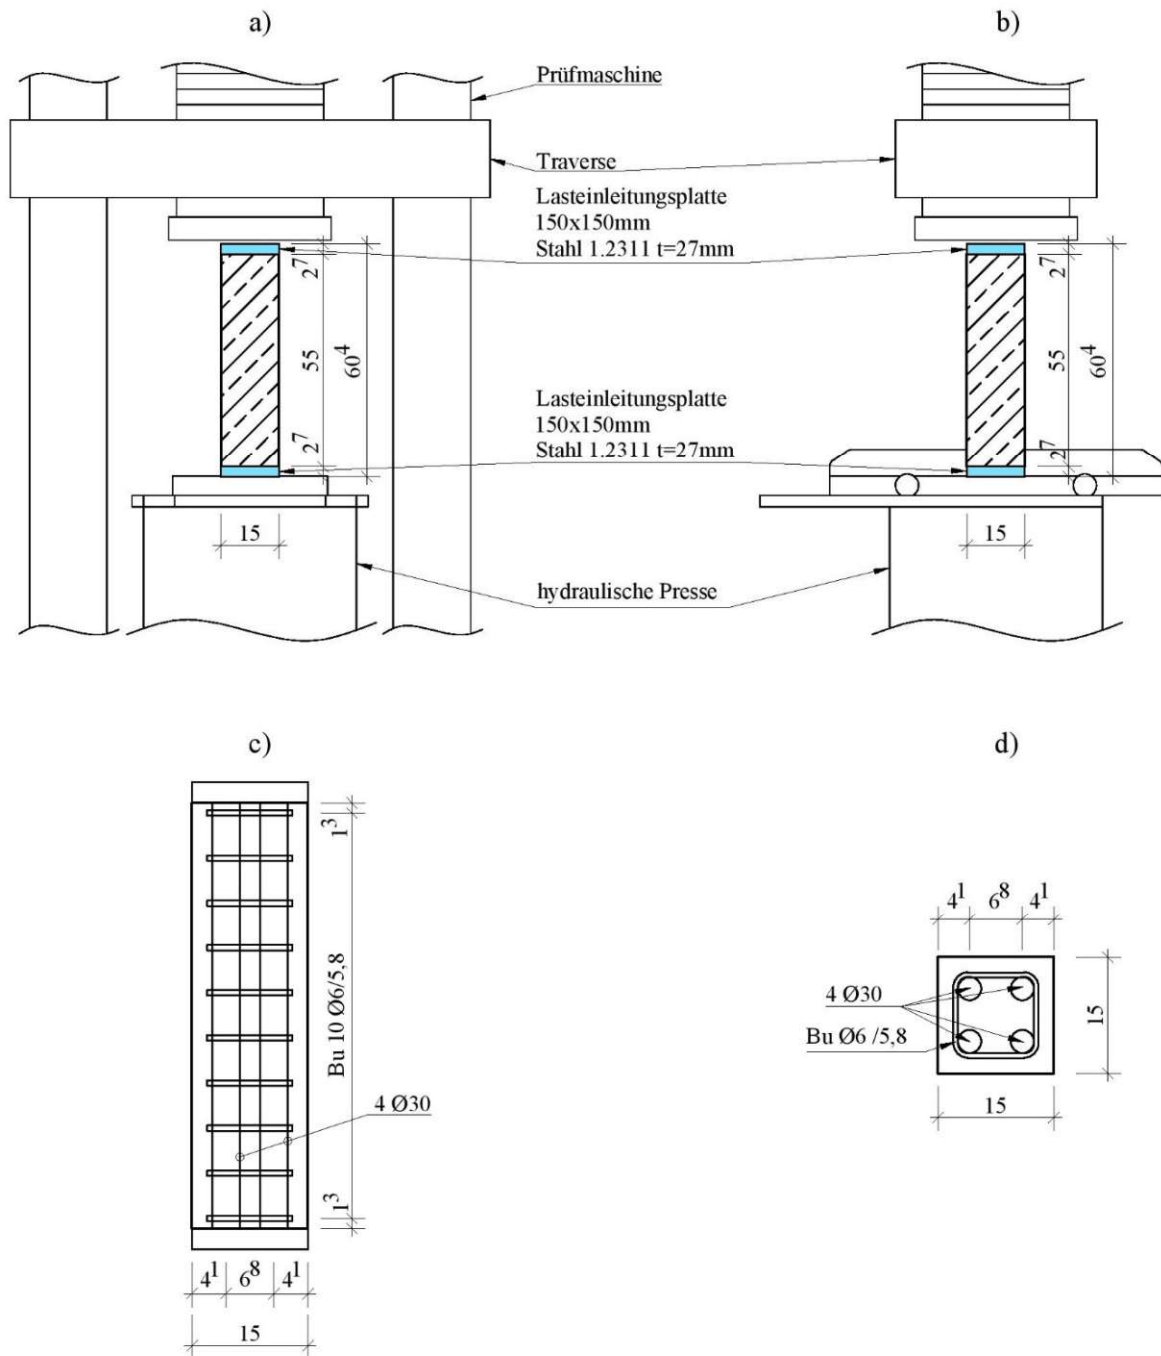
Referenzstütze a) Ansicht von vorne, b) Seitenansicht, c) Bewehrung im Aufriss, d) Bewehrung im Grundriss
